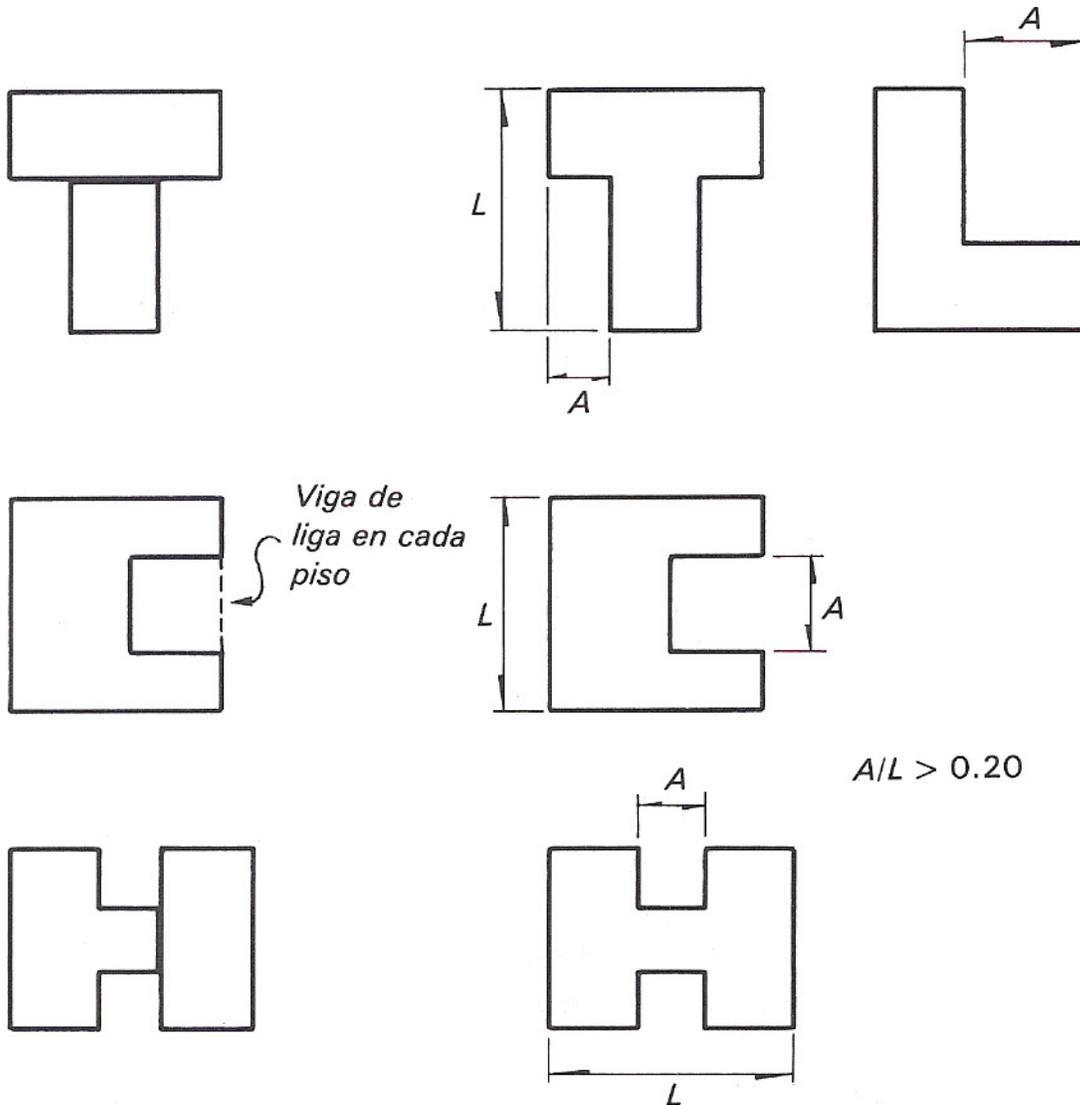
Recomendaciones sobre geometría de la planta de las estructuras para edificios.
